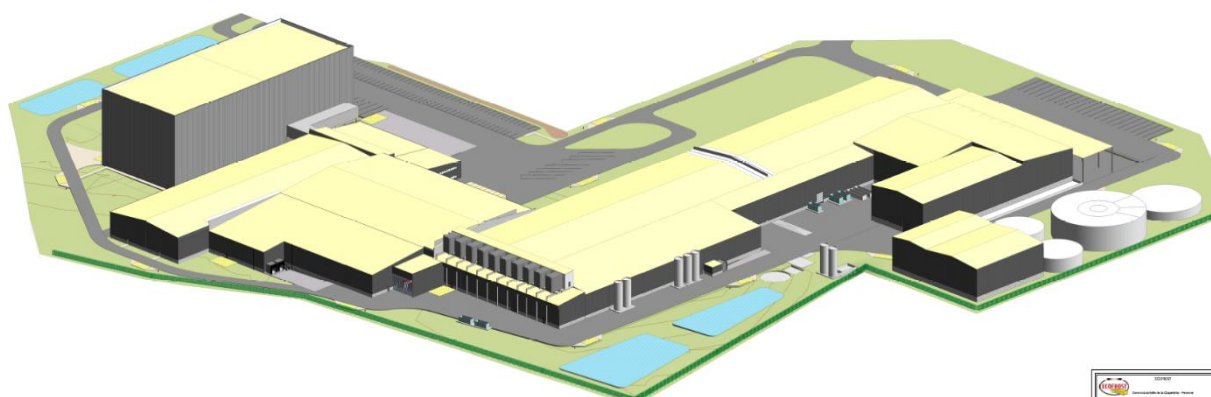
Plan 3D de l'installation (Source : Aconstruct, novembre 2021)
